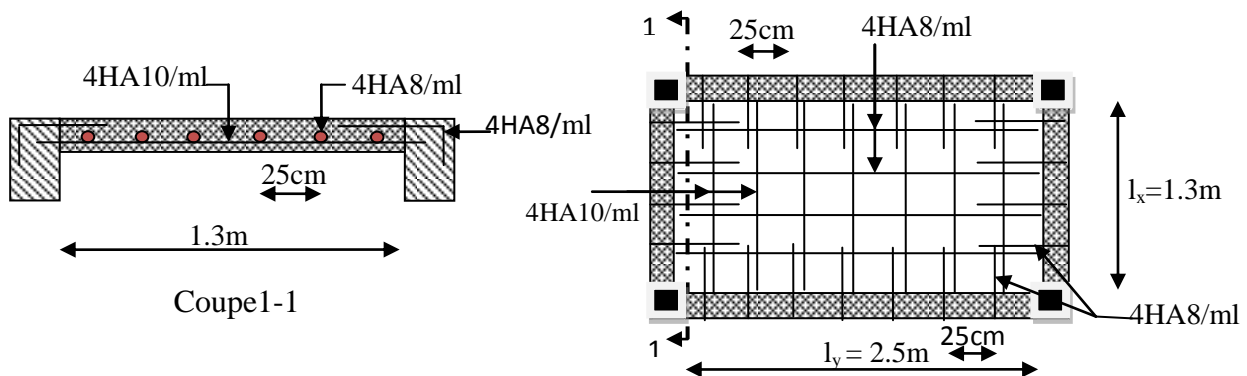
Schéma de ferrailage de la dalle sur 4 appuis.
